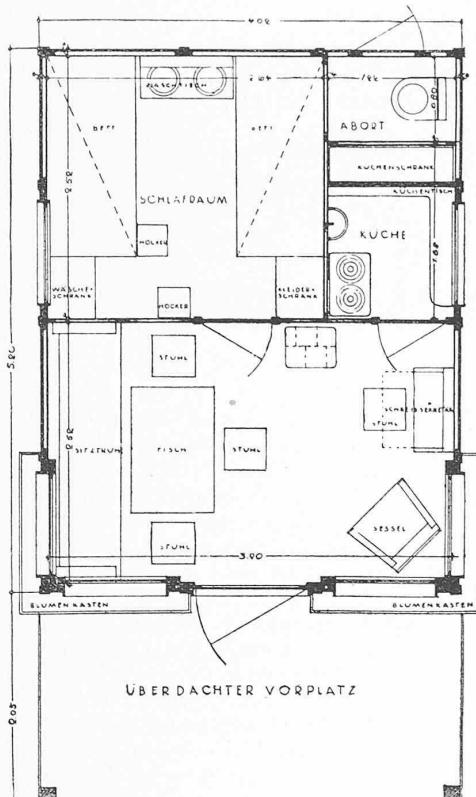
Grundriss zu Abbildung 3. — Maßstab 1 : 50.
